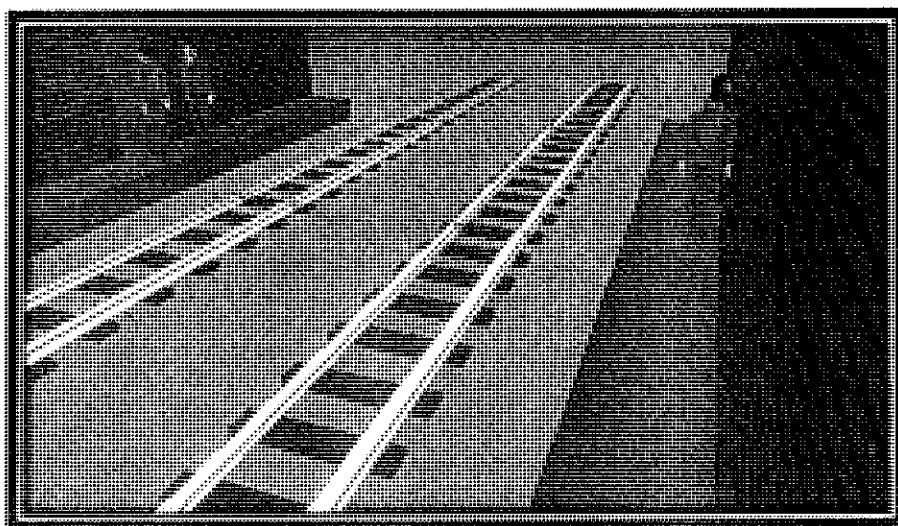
Vista de la Entrada del Pozo Tipo 3
